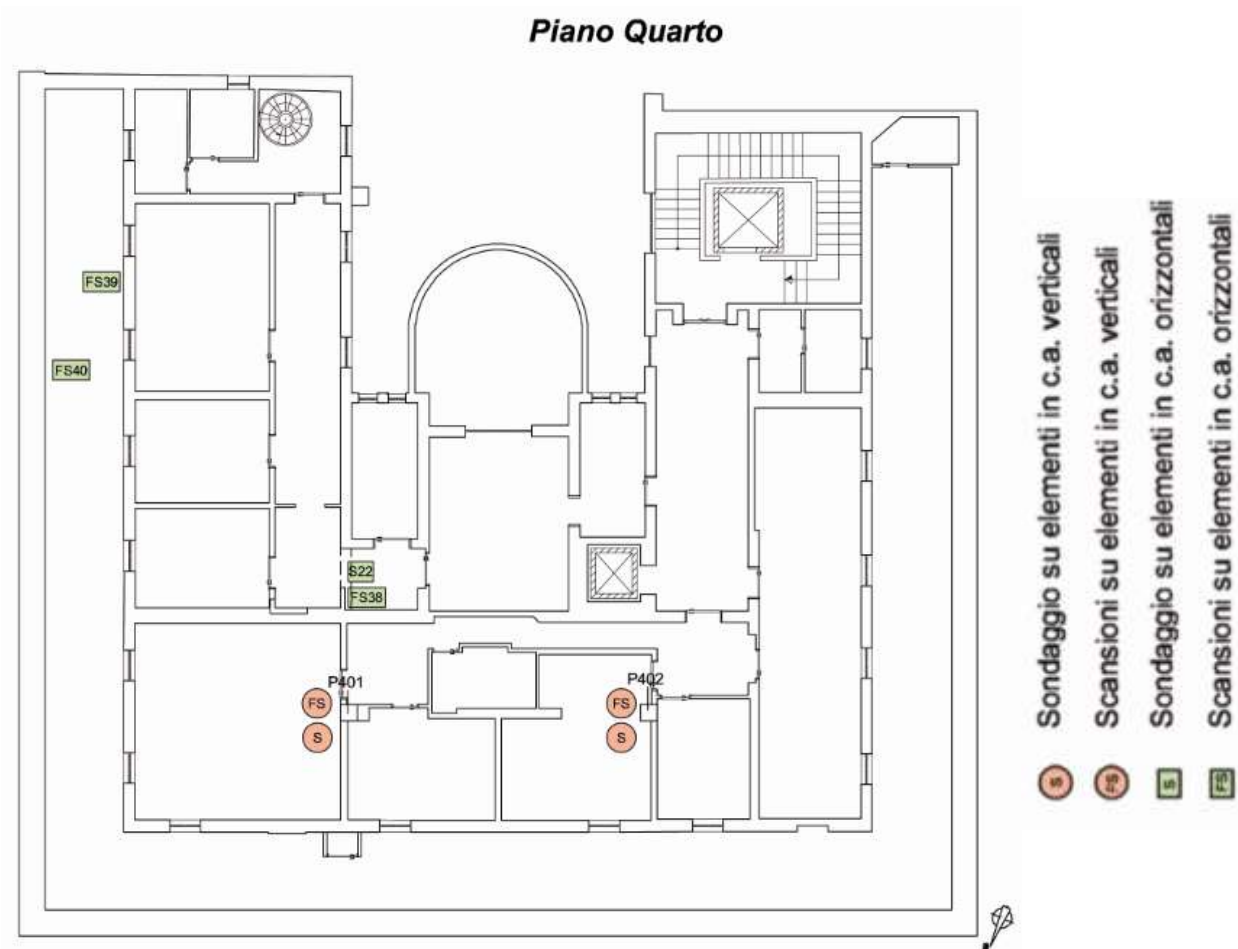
Pianta chiave con indicazione dei punti di sondaggio sugli elementi in c.a. al piano quarto.
